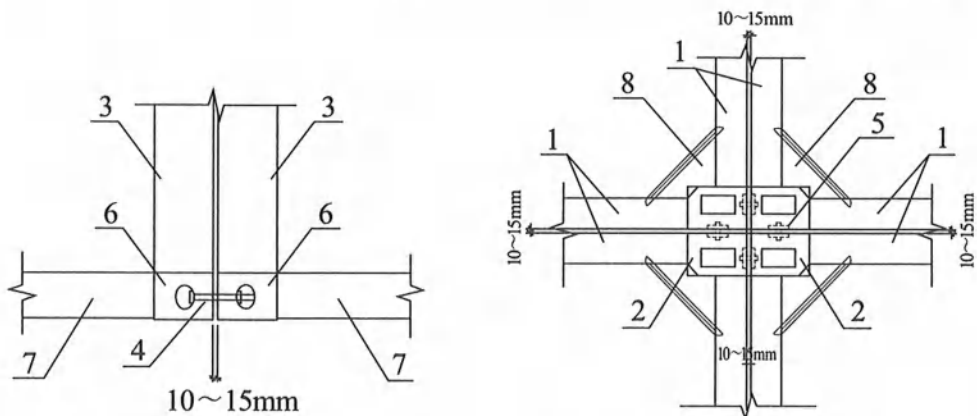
底部立面节点示意图 图 5.3.1-4 顶部平面节点示意图
